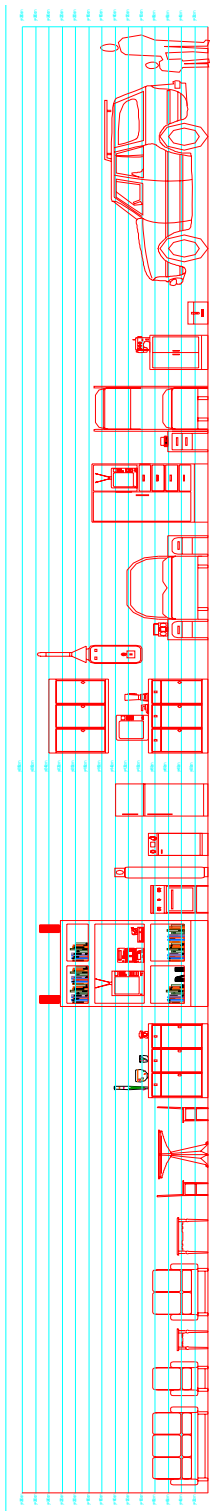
Menaje para la vivienda tipo III (una sola planta)
